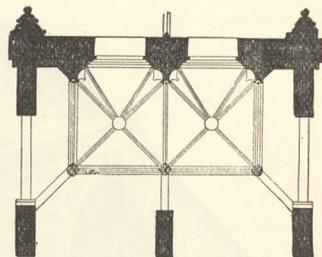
Porche de Saint-Urbain, à Troyes. Plan.
